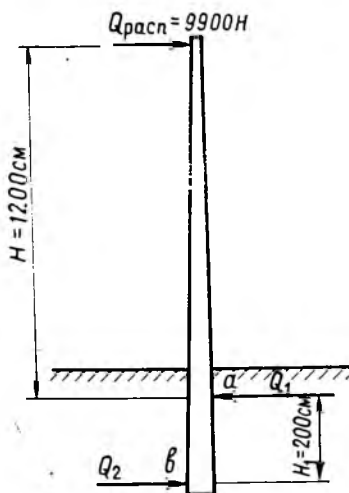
Расчетная схема для определения поперечных сил, действующих в фундаменте стойки
